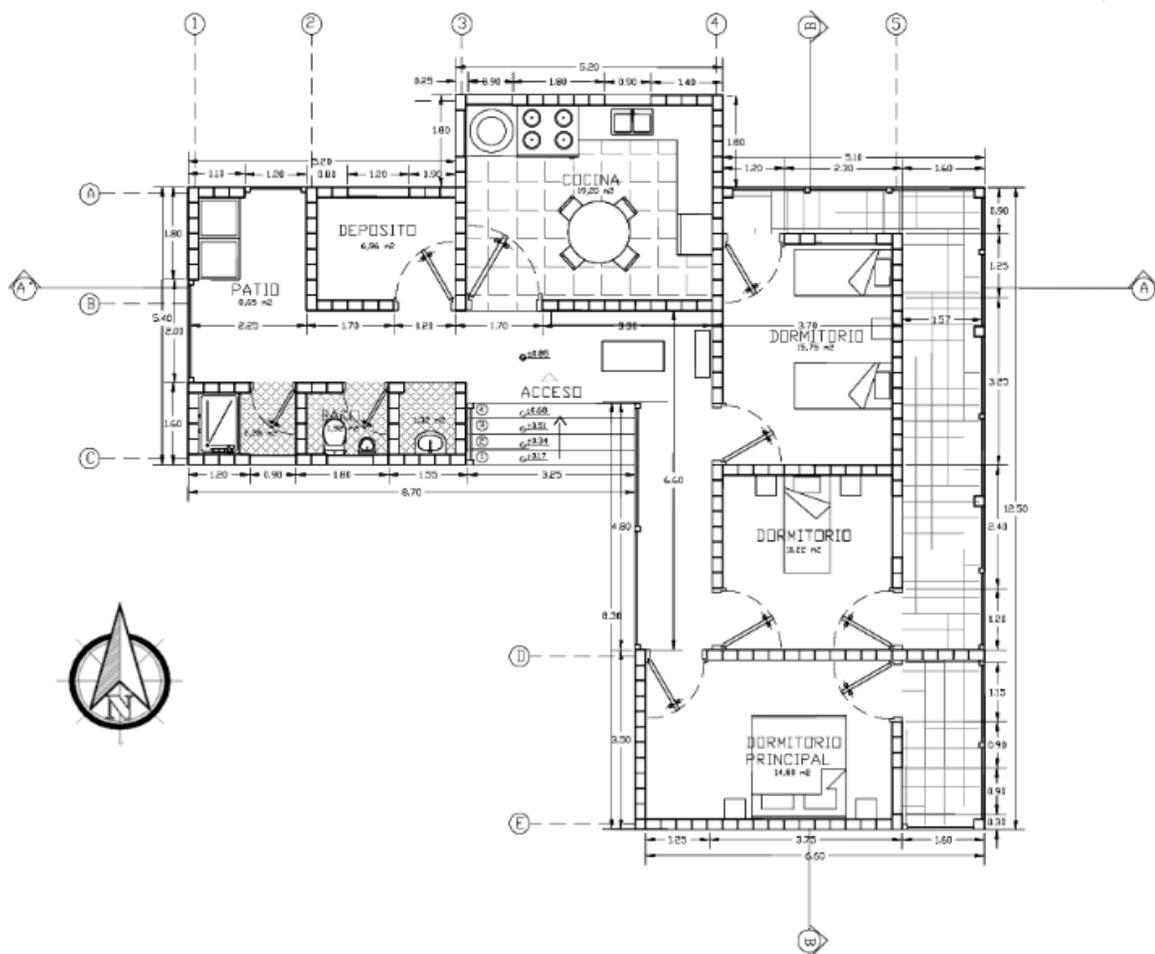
Planta Vivienda clima frío. Escala gráfica. Elaboración propia
